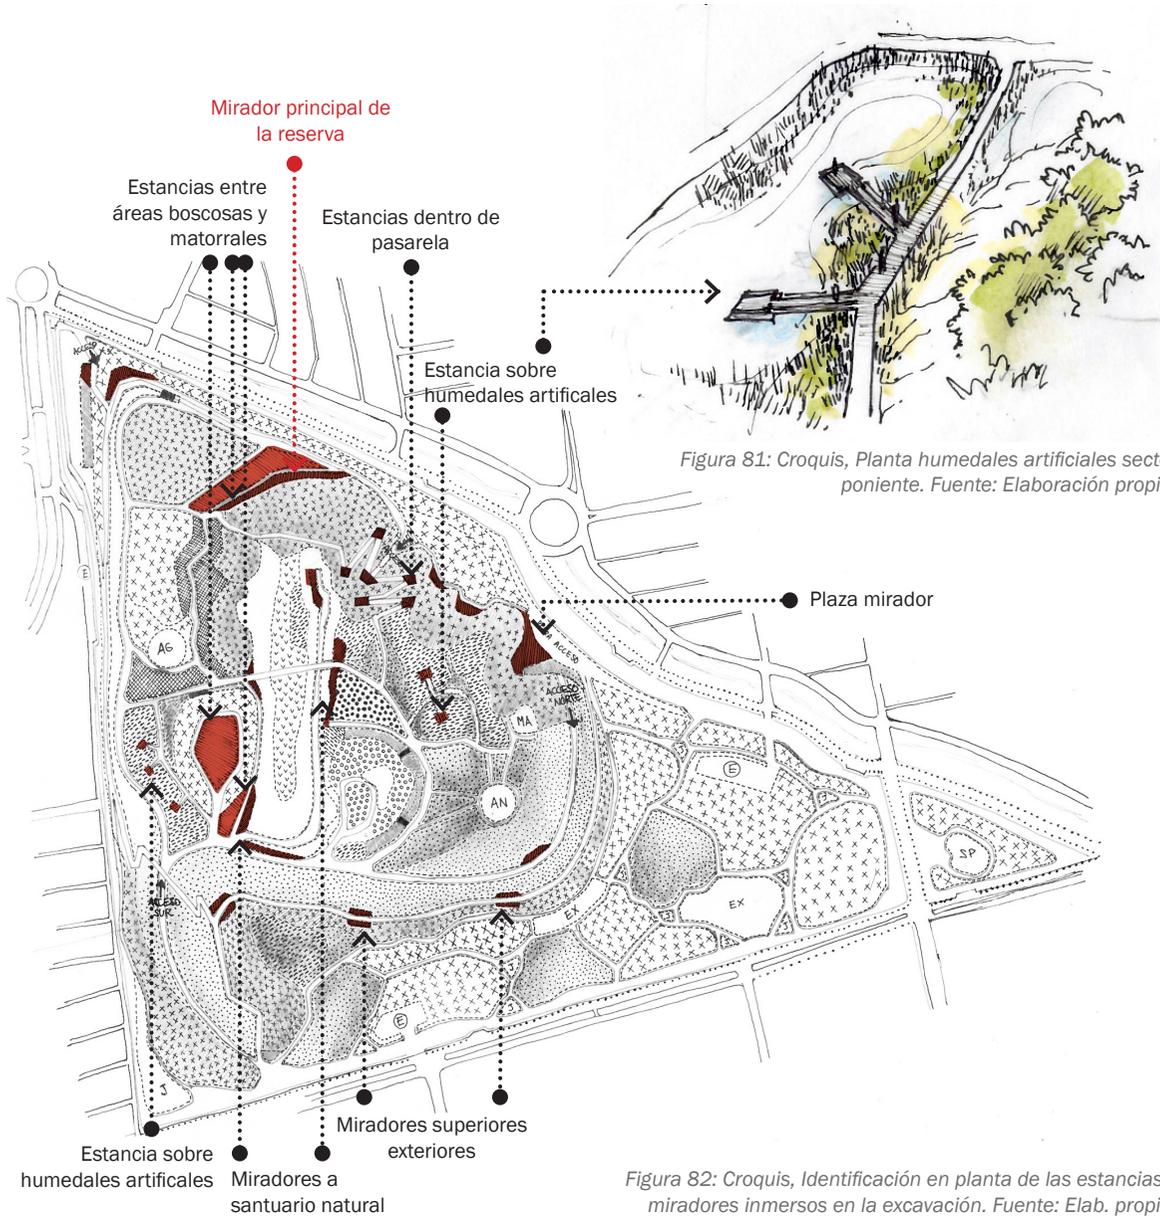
Croquis, Identificación en planta de las estancias y miradores inmersos en la excavación. Fuente: Elab. propia.
